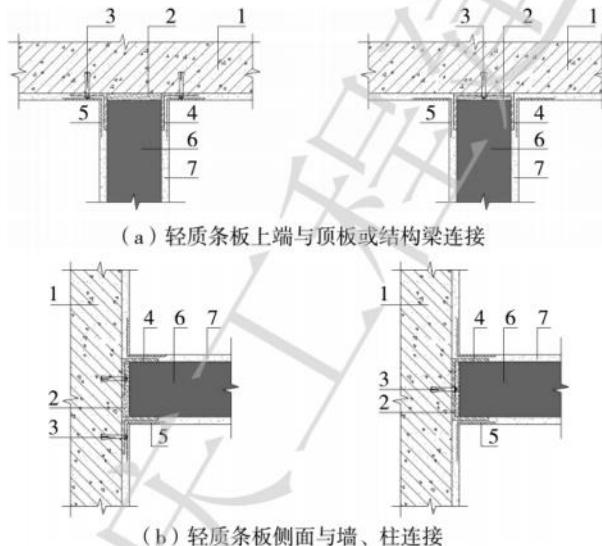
隔墙轻质条板与混凝土结构连接示意图
